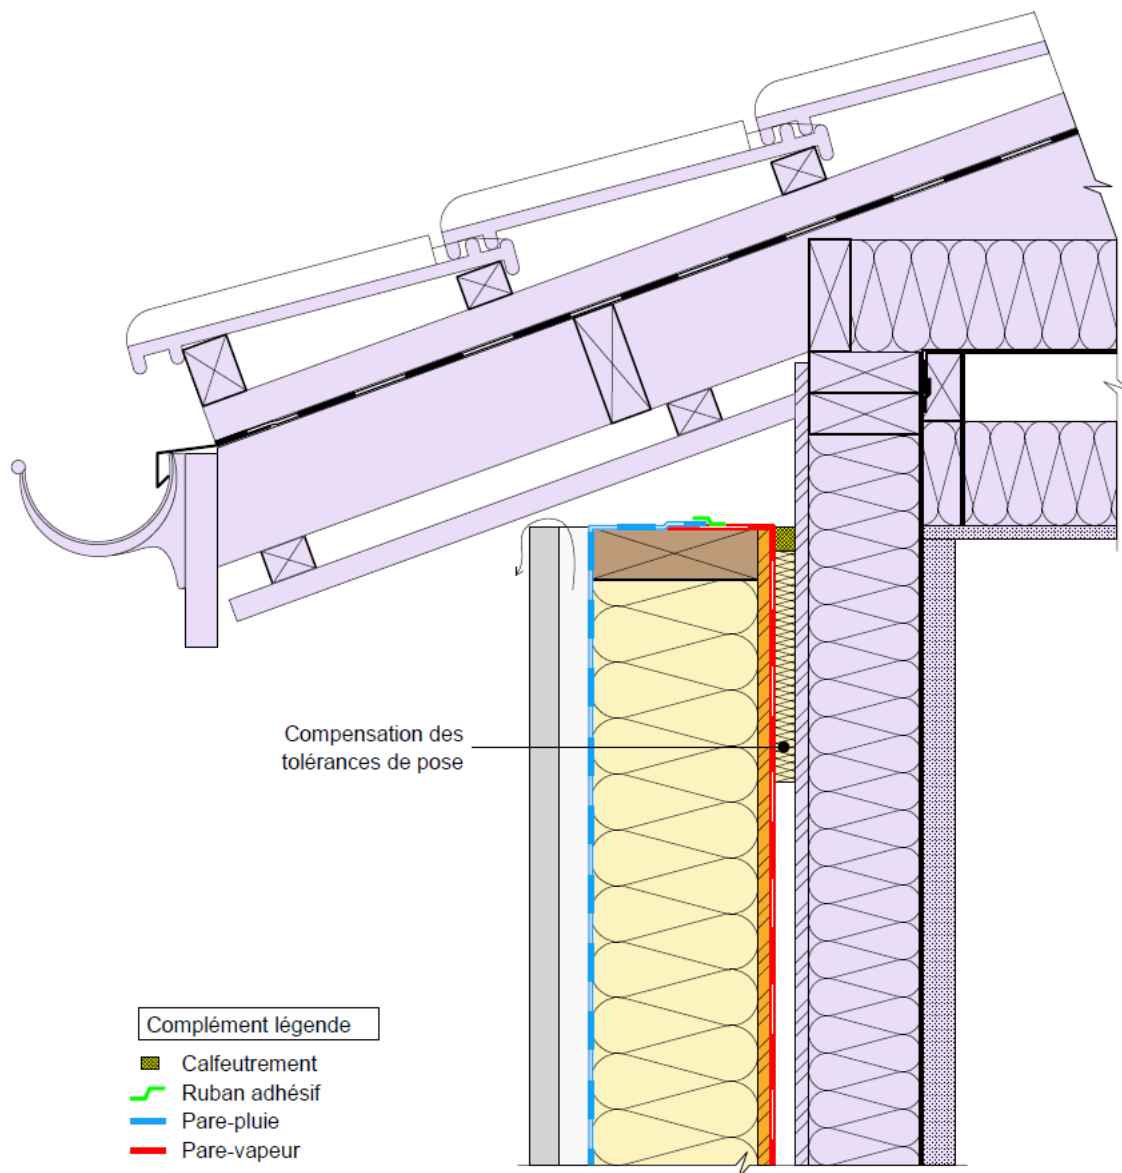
Raccordement sous débord de toiture (coupe verticale)
